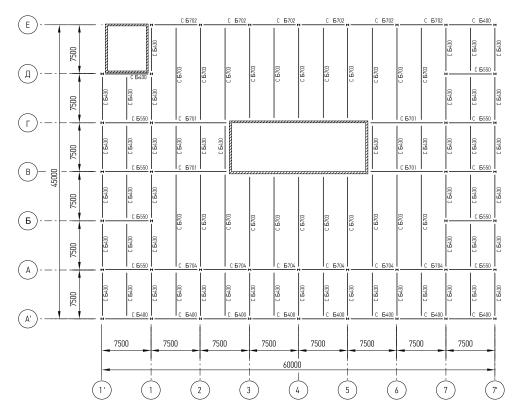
Вариант каркаса с применением стальных конструкций при сетке 7,5 х15 м. Маркировочный план несущих конструкций перекрытия первого этажа
